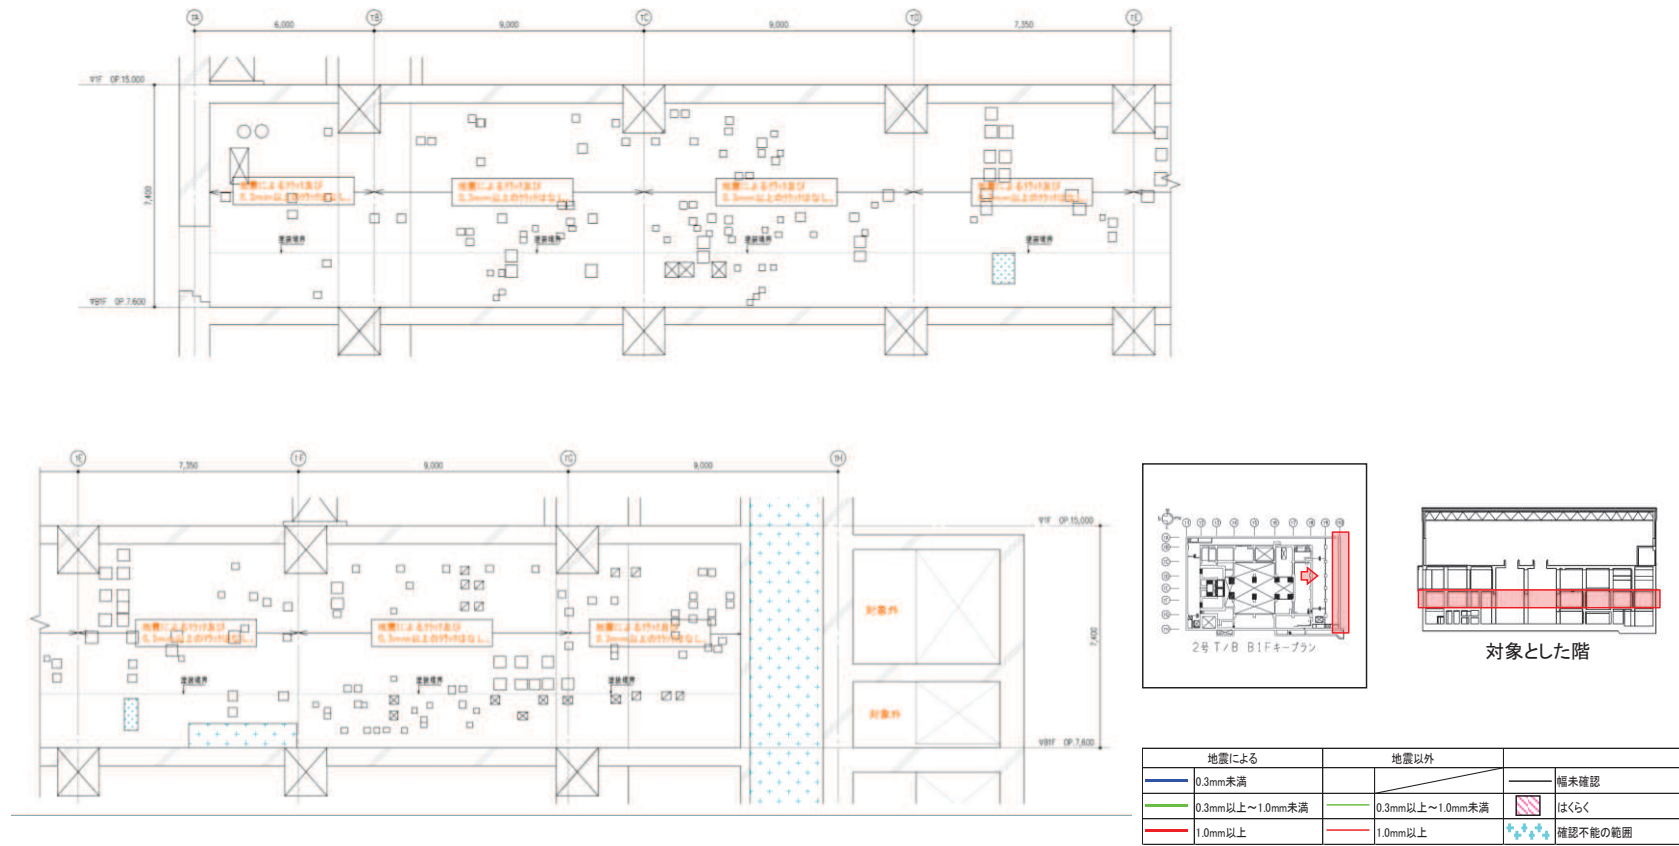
タービン建屋のひび割れ分布 耐震壁 (25) 地下 1 階 T10 通り
